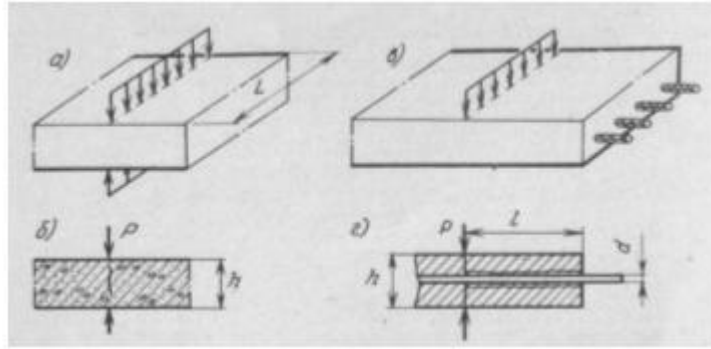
Схема завантаження бетонних і залізобетонних виробів при руйнуванні: а, в - схеми положення навантаження; б, д - схеми руйнування бетону і залізобетону.
